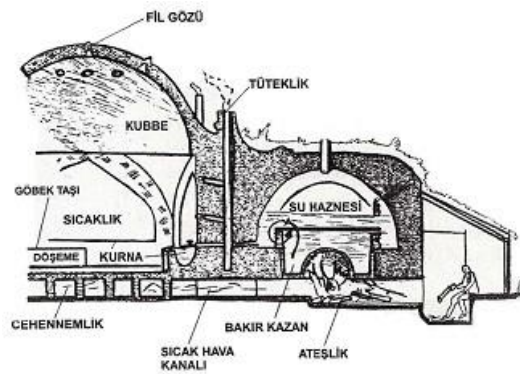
Hypocaust ısıtma sistemi plan ve kesit gösterimi
